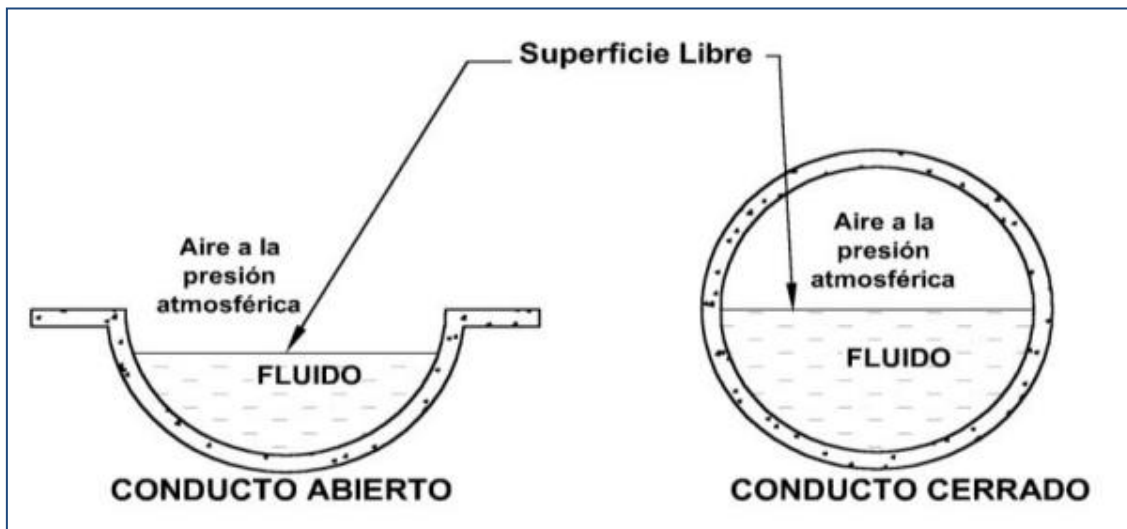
Sección transversal de un conducto abierto y un conducto cerrado. Fuente: Rodríguez, 2008.
